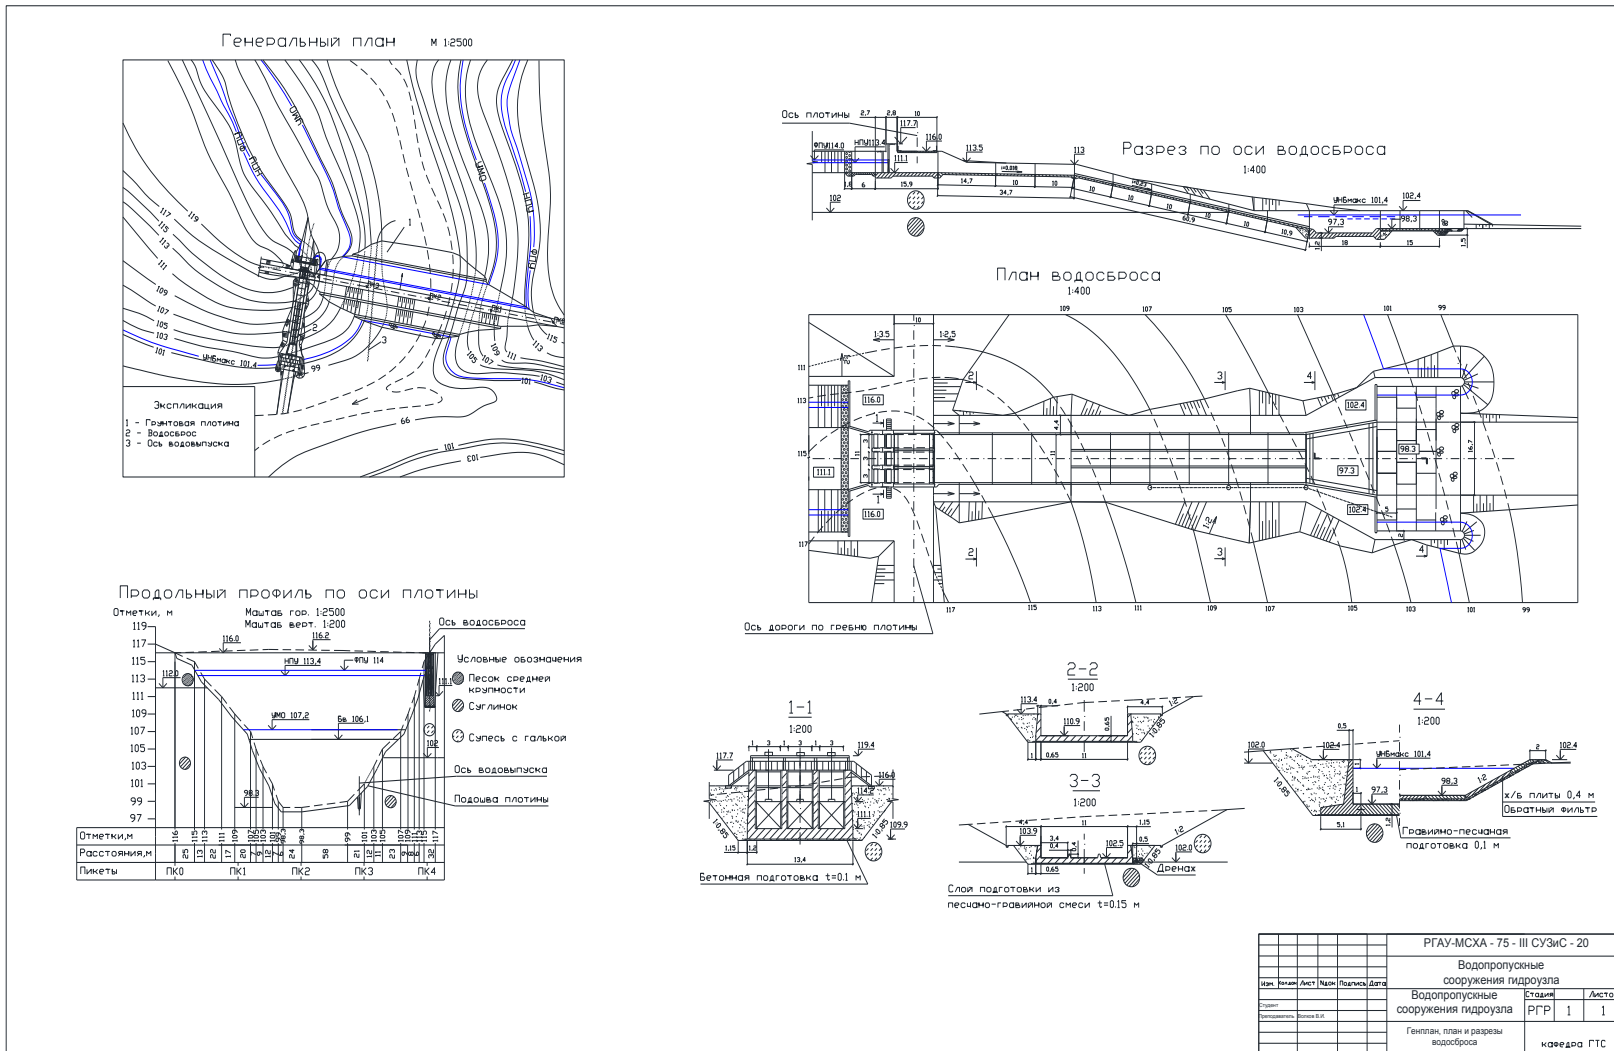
Водопропускные сооружения гидроузла с грунтовой плотиной
